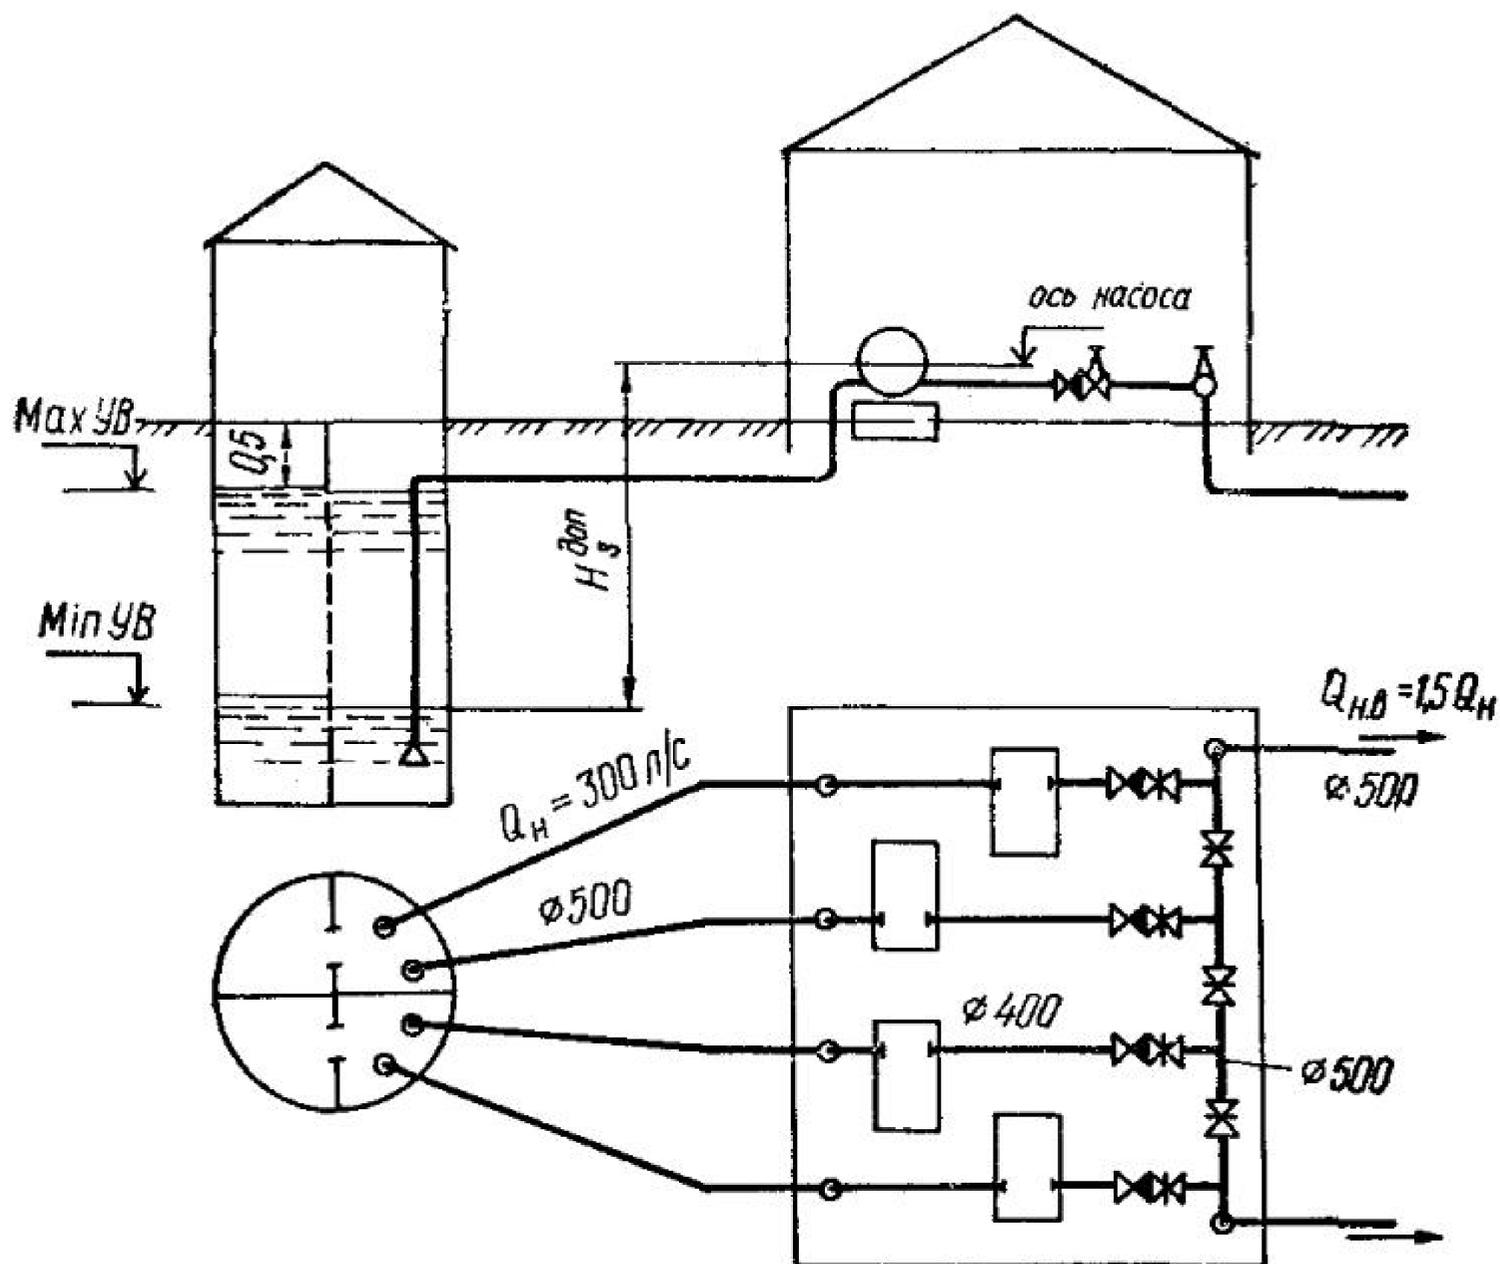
Схема размещения насосов, трубопроводов и арматуры в насосной станции I подъема
